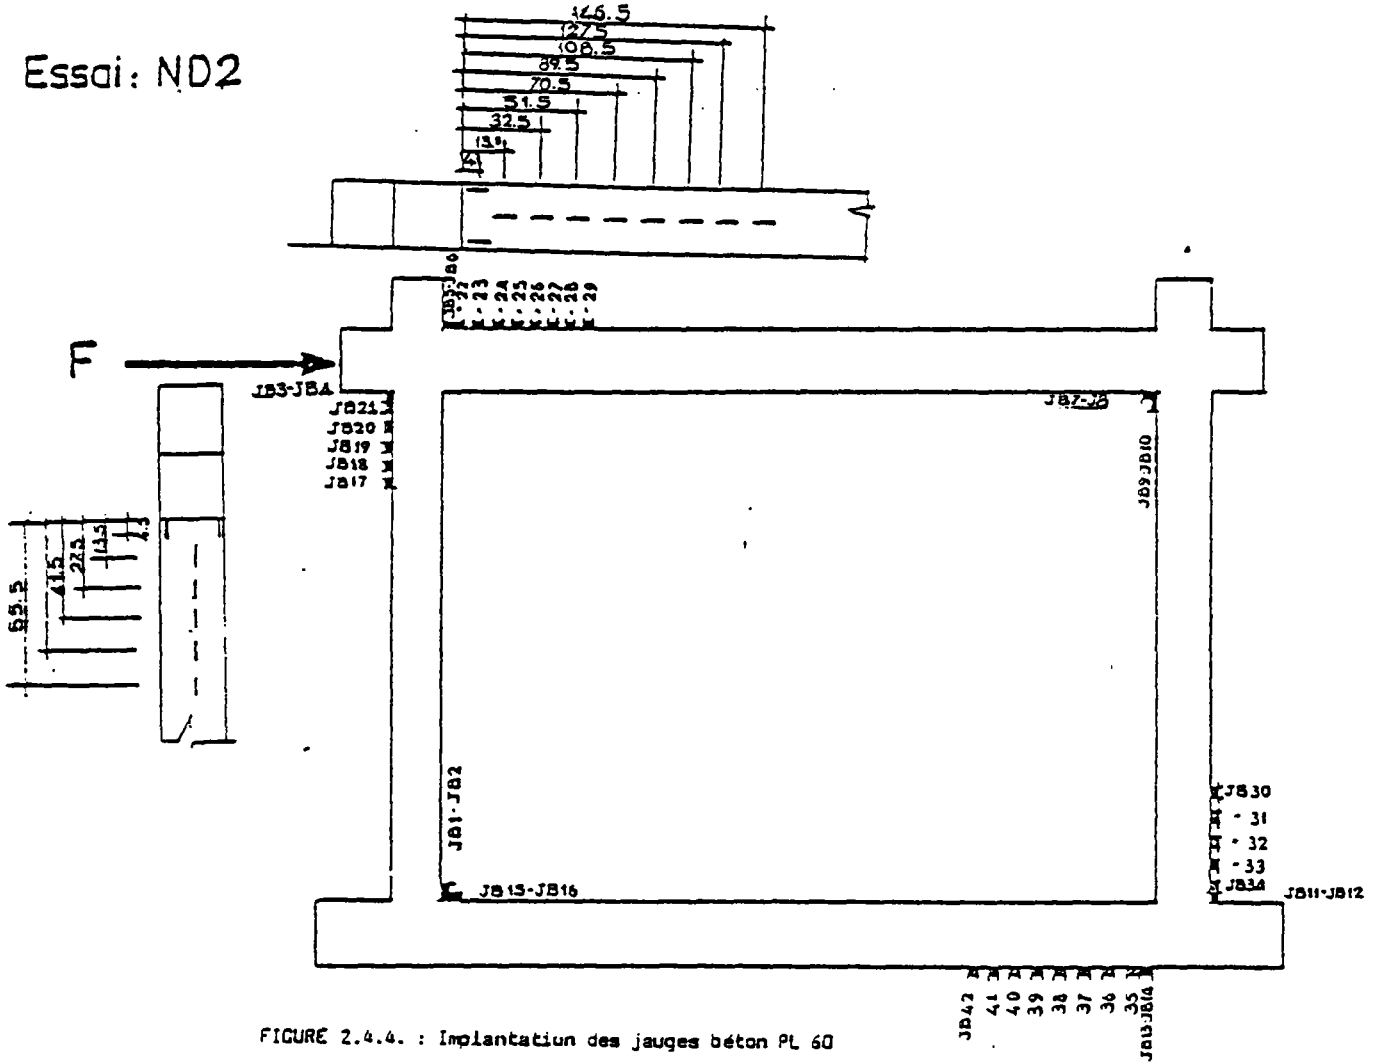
Implantation des jauges béton PL 60
